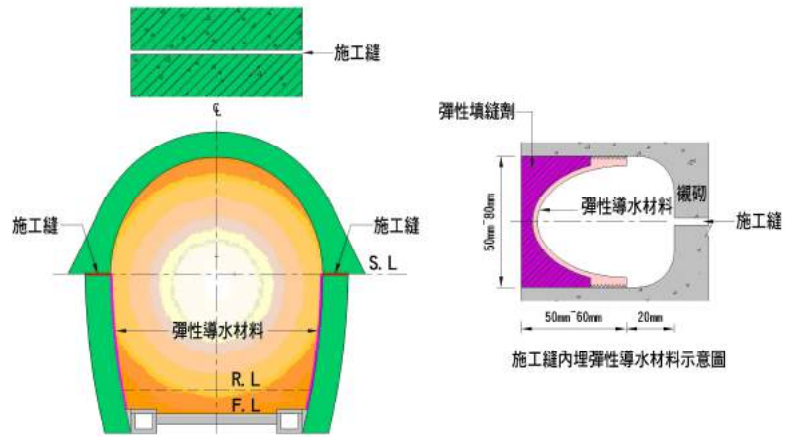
施工縫導水工法示意圖(TYPE C3)
